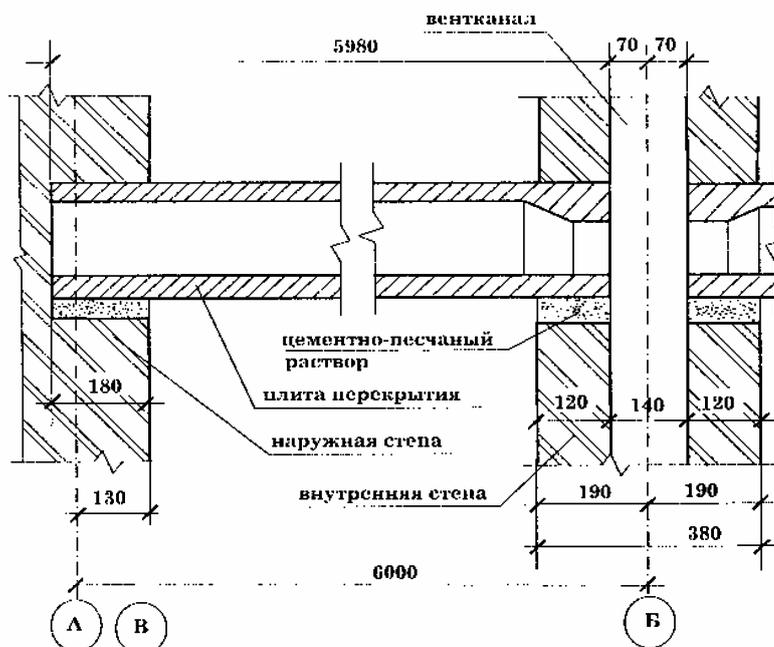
Устройство вентиляционных каналов во внутренней стене
